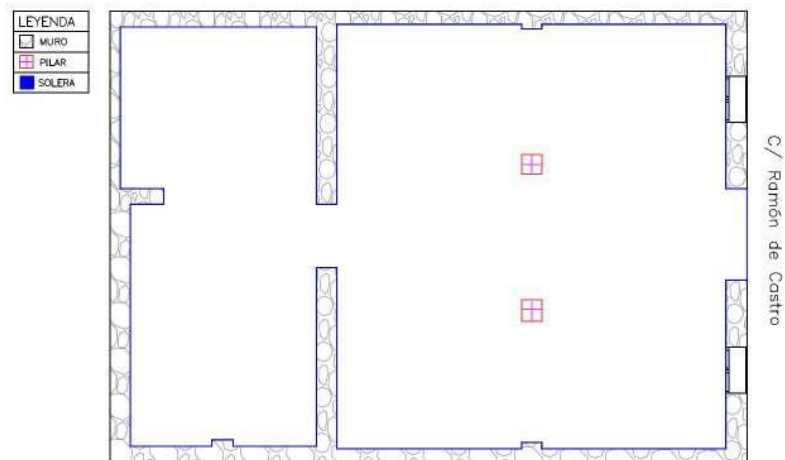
Detalle constructivo forjado en vivienda existente. Fuente propia
